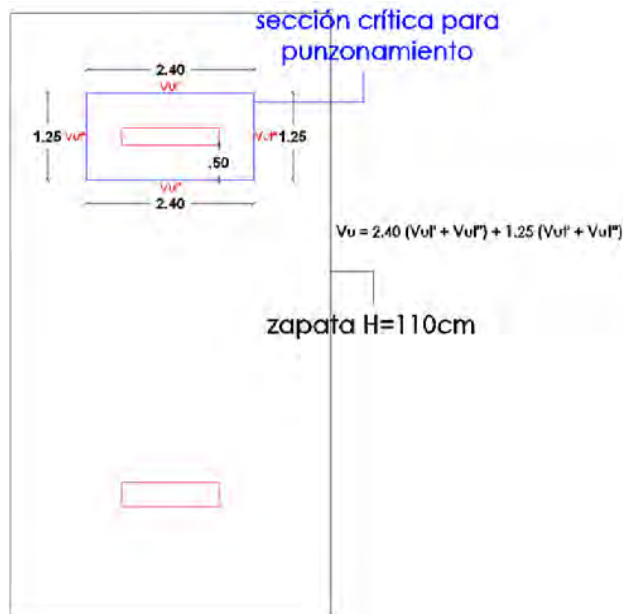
Propuesta de cimentación para las placas PL06 y PL07
